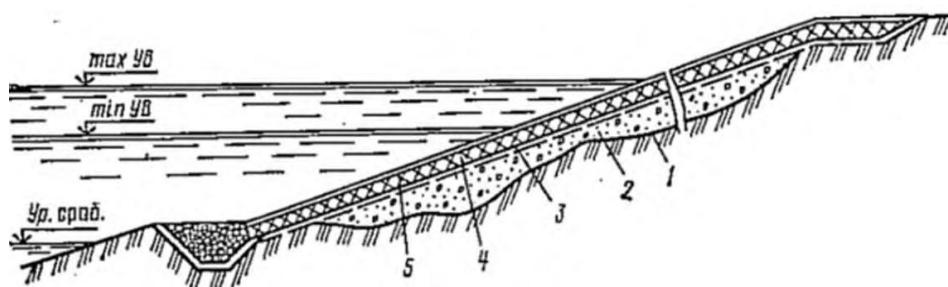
Восстановление крепления откоса плотины асфальтобетонной облицовкой [17]: 1 – границы разрушения откоса; 2 – промоина, заполненная песчано-гравийным грунтом; 3 – зона протравленного ядохимикатами; 4 – асфальтобетонное покрытие; 5 – обработанная поверхность
